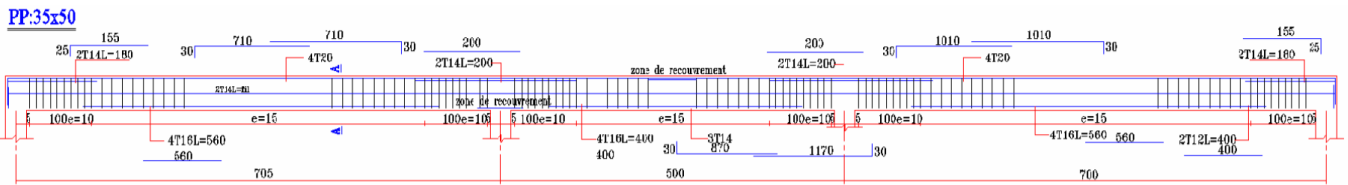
ferrailage de poutre principale (35x50)cm
